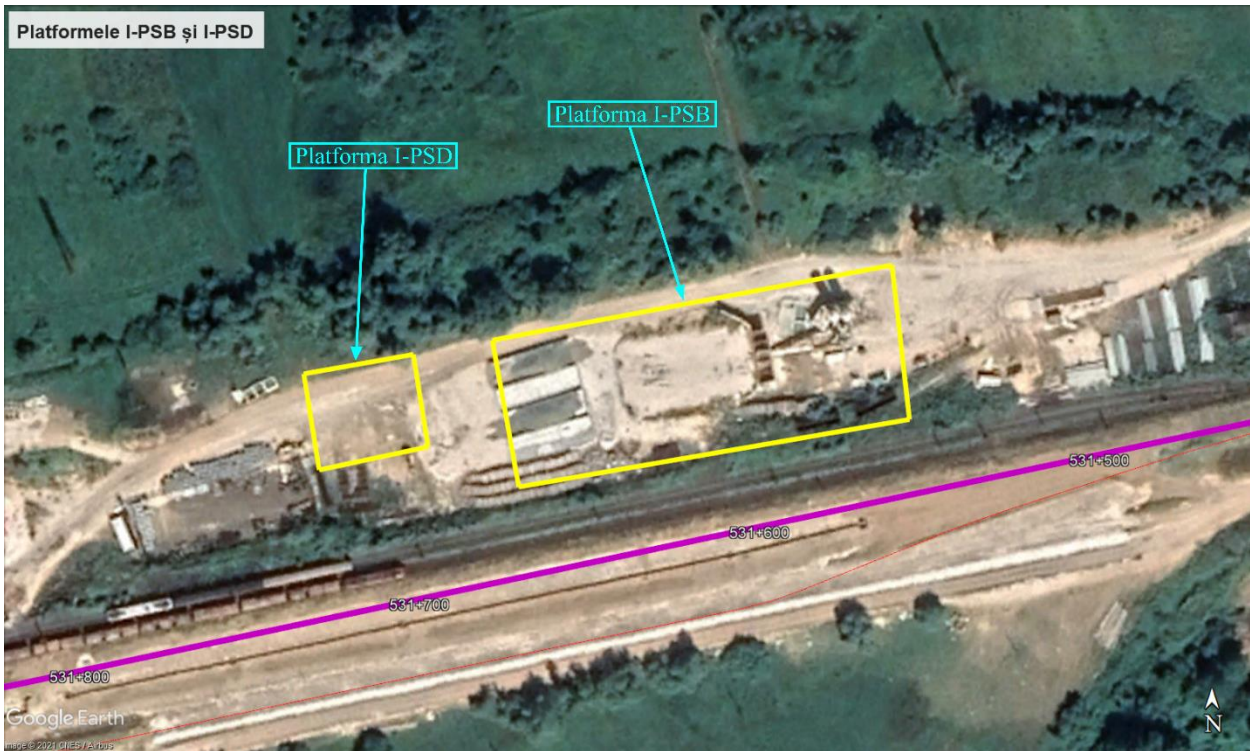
Plan de amplasament pentru platformele I-PSD și I-PSB, jud. Arad – vedere din satelit
